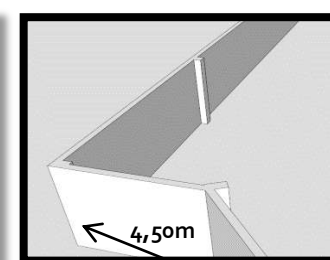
photo représente un mur de contreventement d'angle,Src :auteur
